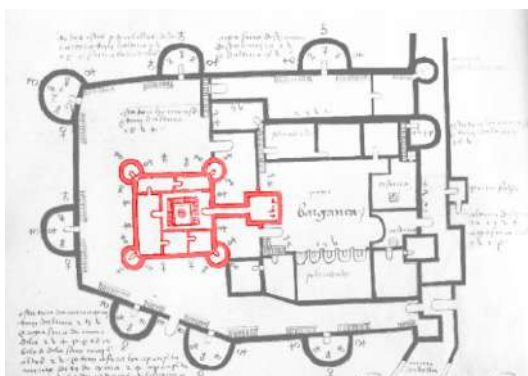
e 015 | Planta e alçado norte da torre de menagem do castelo de Monsaraz
